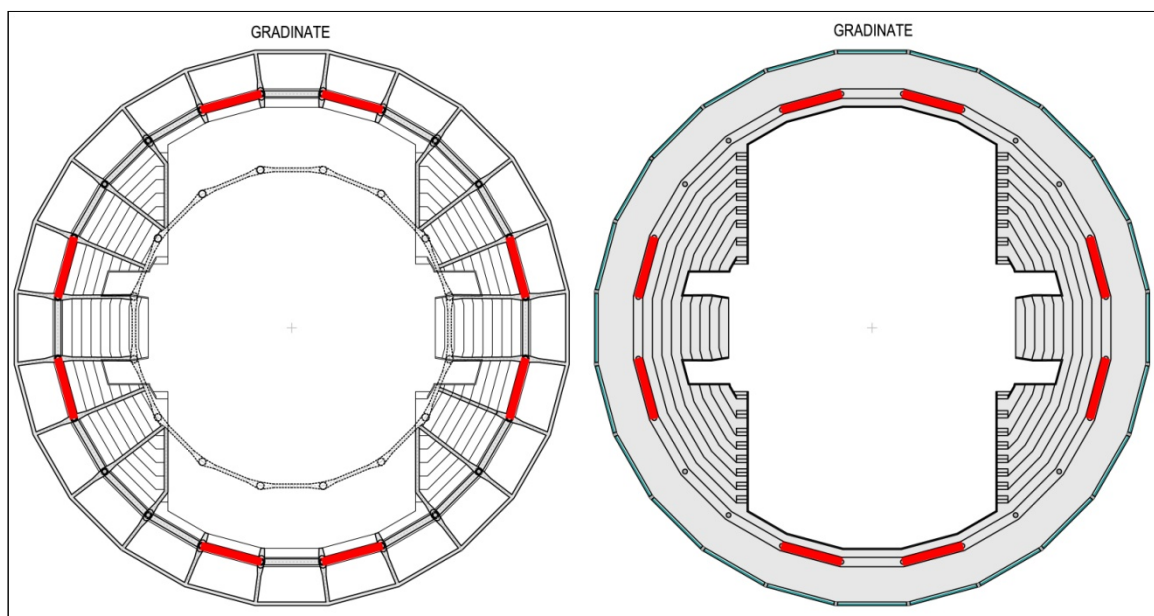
pianta strutturale ed architettonica del piano gradinate con rappresentazione degli interventi
